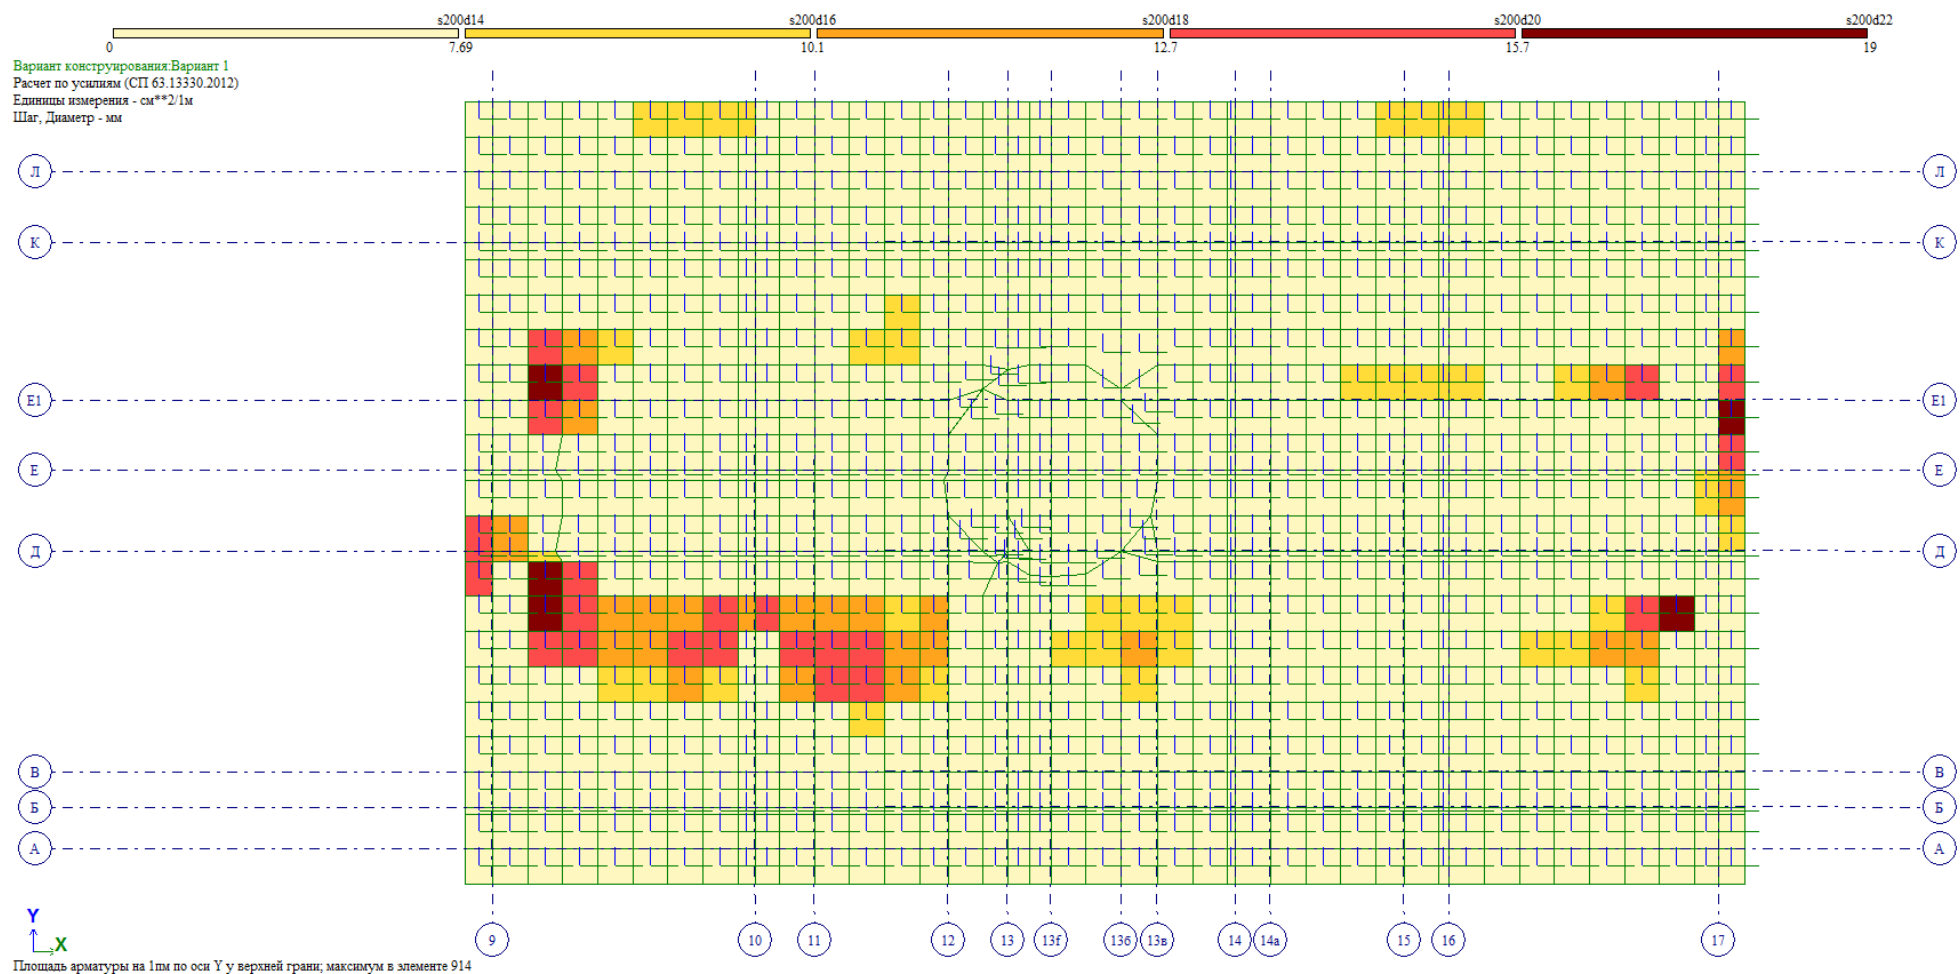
Площадь арматуры у верхней грани фундаментной плиты по оси Y (карстовая воронка расположена в осях 13/E секции В
